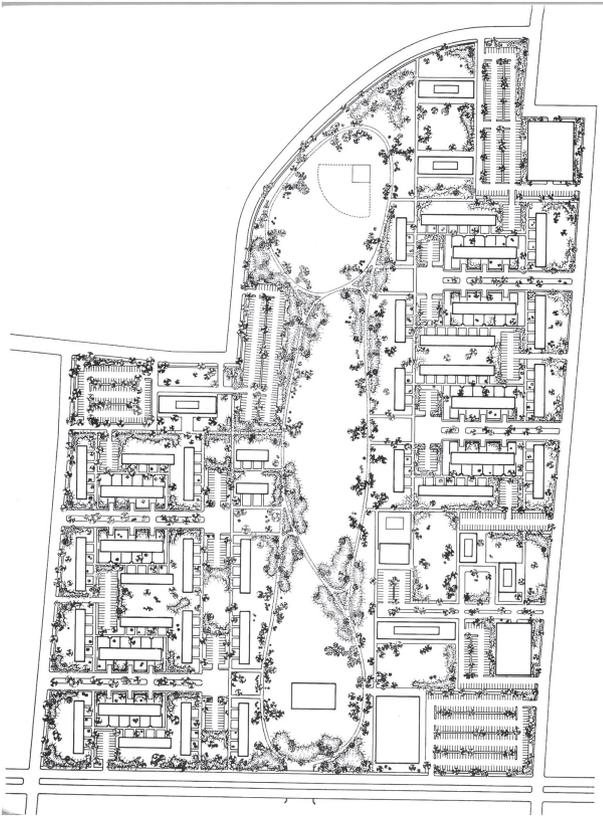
Planta de Lafayette Park. Detroit. Mies, Hilberseimer y Caldwell. 1956.
